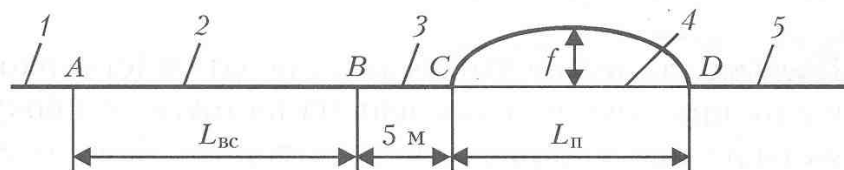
Схема вигину пліті перед зварюванням при виготовленні її методом часткового розкріплення: 1 – закріплена ділянка пліті, на якій знаходиться ПРЗМ; 2 – вварювана вставка з ослабленими клемами; 3 – пряма ділянка пліті, що приварюється; 4 – ділянка CD зі знятими клемами і вигином; 5 – закріплена пліть; А – перший, В – другий стик зварювання; f – стріла вигину пліті; $L_{вс}$ – довжина ділянки вигину; $L_{вв}$ – довжина вставки, що вварюється
